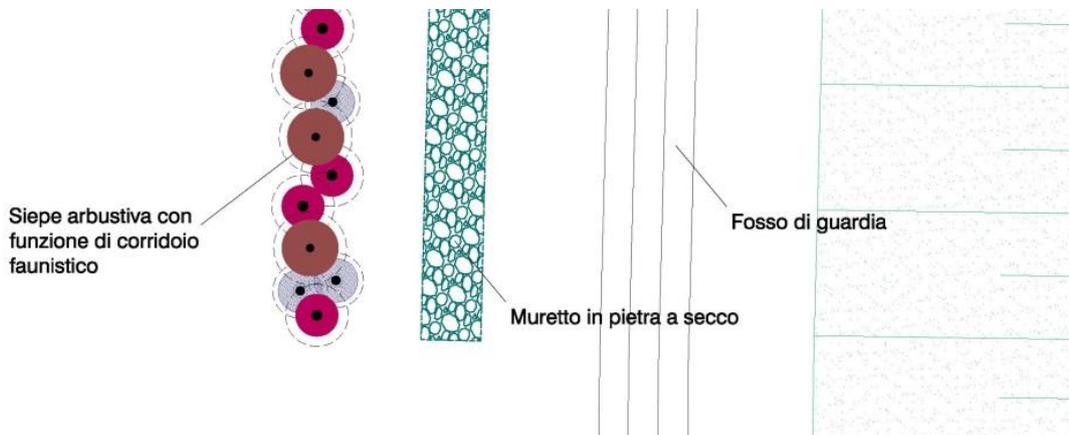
Stralcio planimetrico area di Lunafras – Lotto 4
